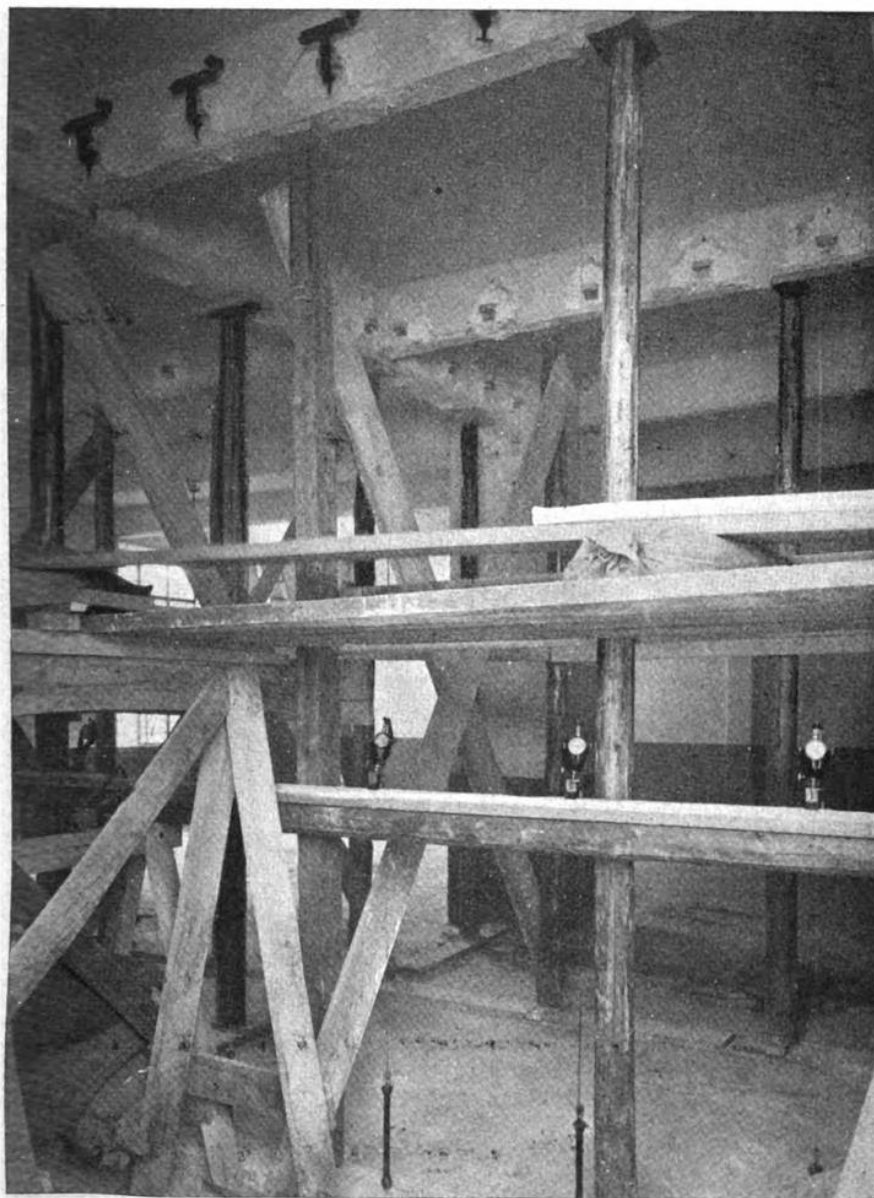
Disposizione degli strumenti sulla nervatura secondaria «C»
